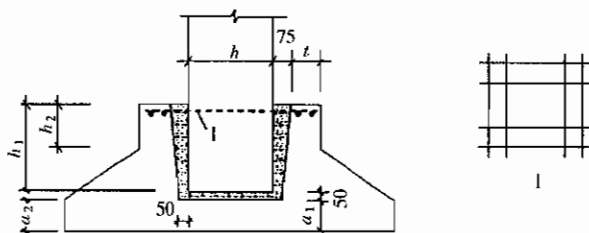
预制钢筋混凝土柱与杯口基础的连接示意
